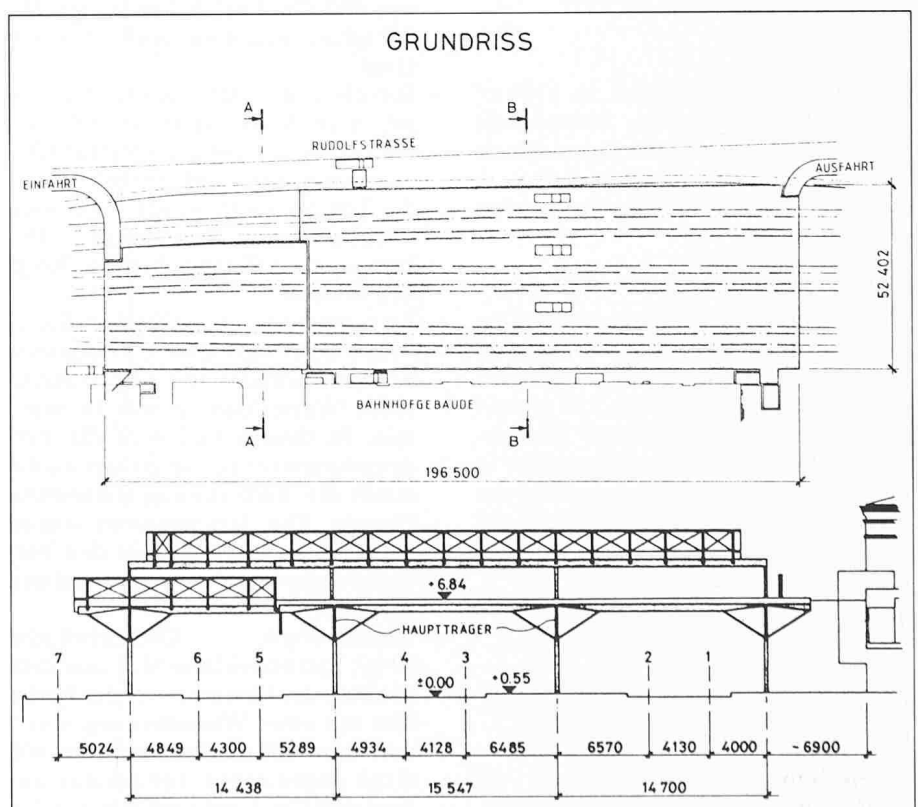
Grundriss und Schnitt des Parkhauses über den Geleisen des Bahnhofes Winterthur
